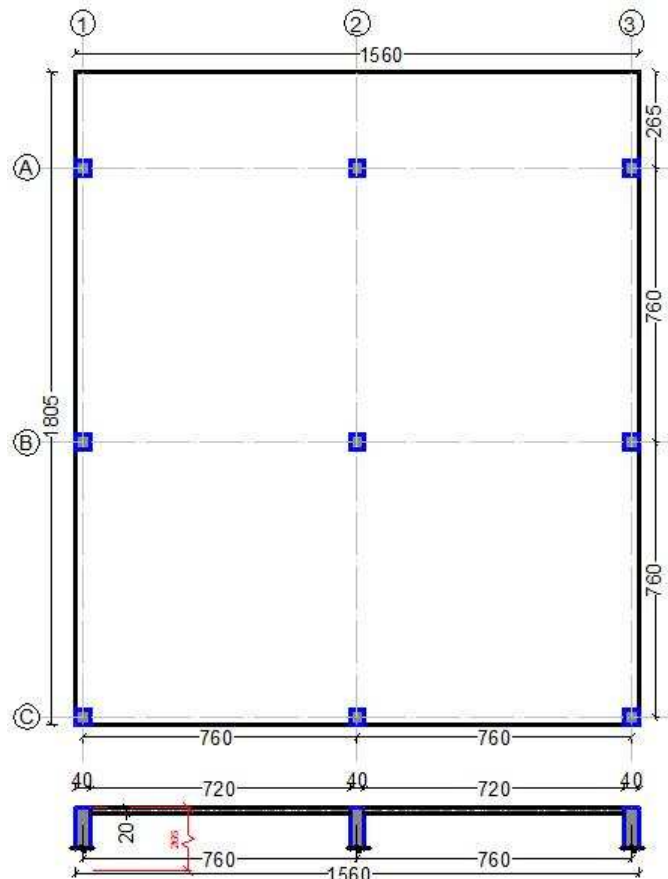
Planta baixa e elevação da FÔRMA_4
